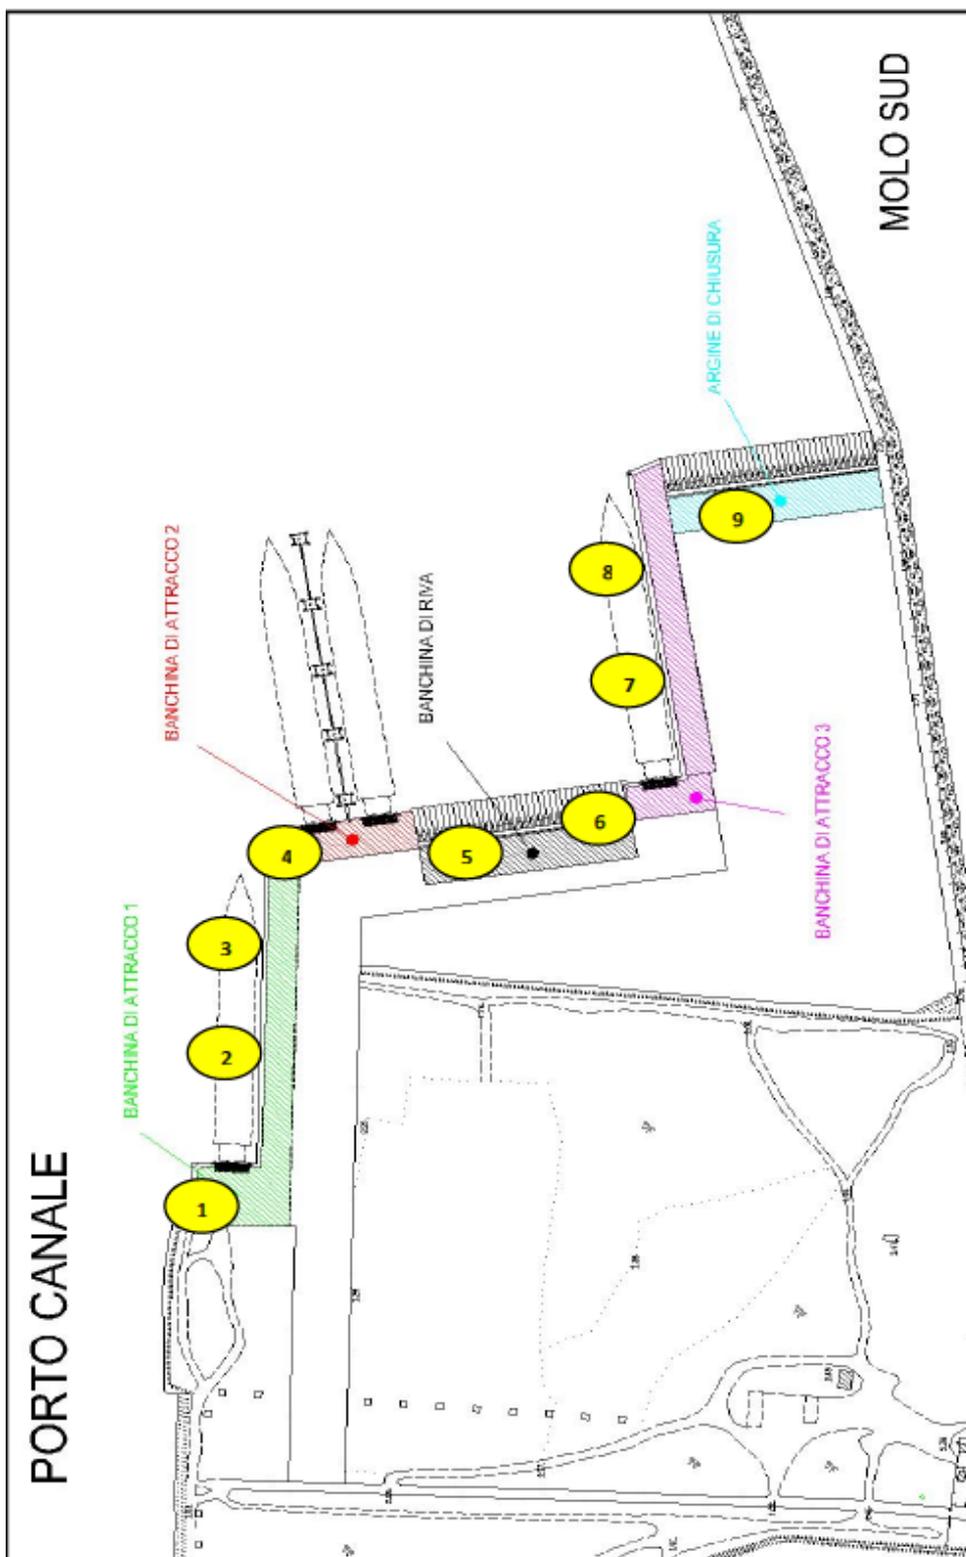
Planimetria degli interventi di progetto con l'indicazione delle sezioni analizzate
